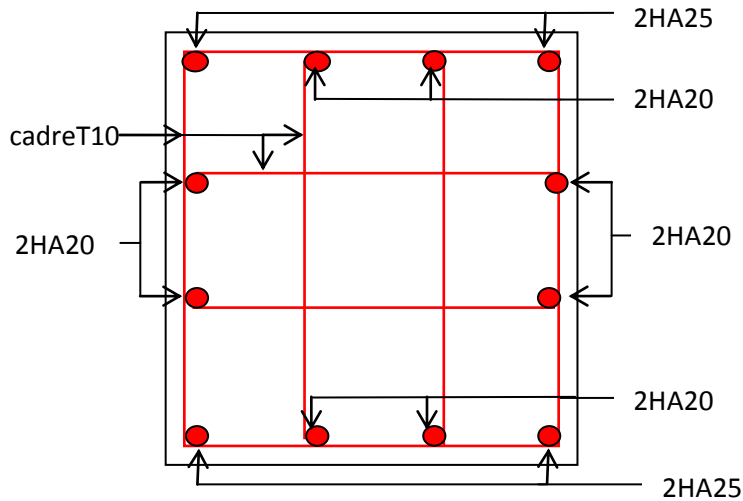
Ferrailage poteau RDC et 1^{ère}
